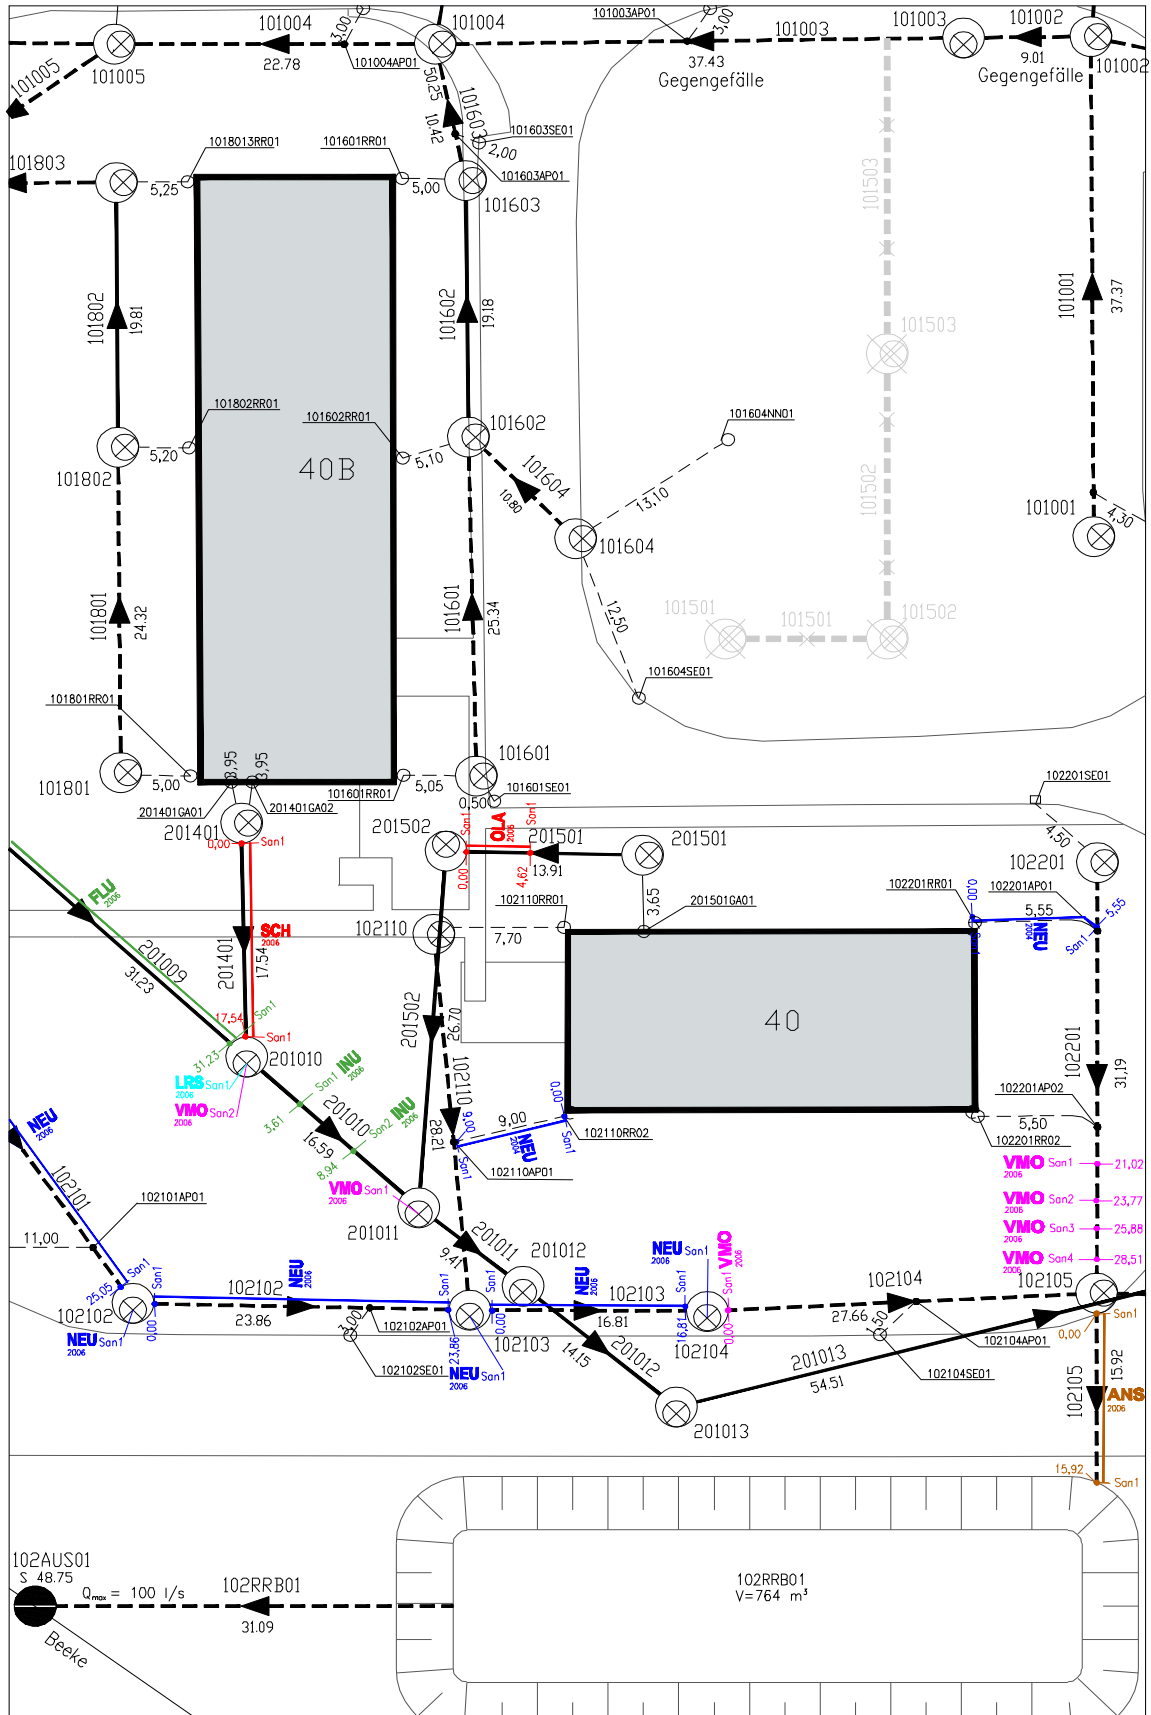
6 Beispielplan: Lageplan „Bestand Sanierung“
